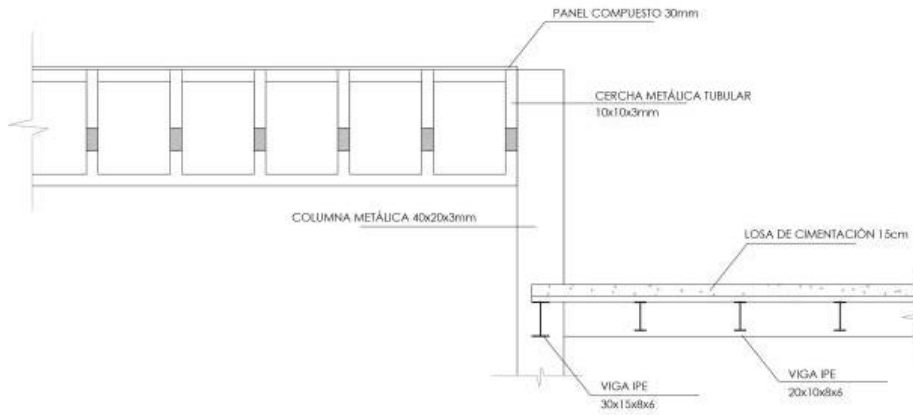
Detalle cubierta bloque 1. Fuente: ilustraciones propias
